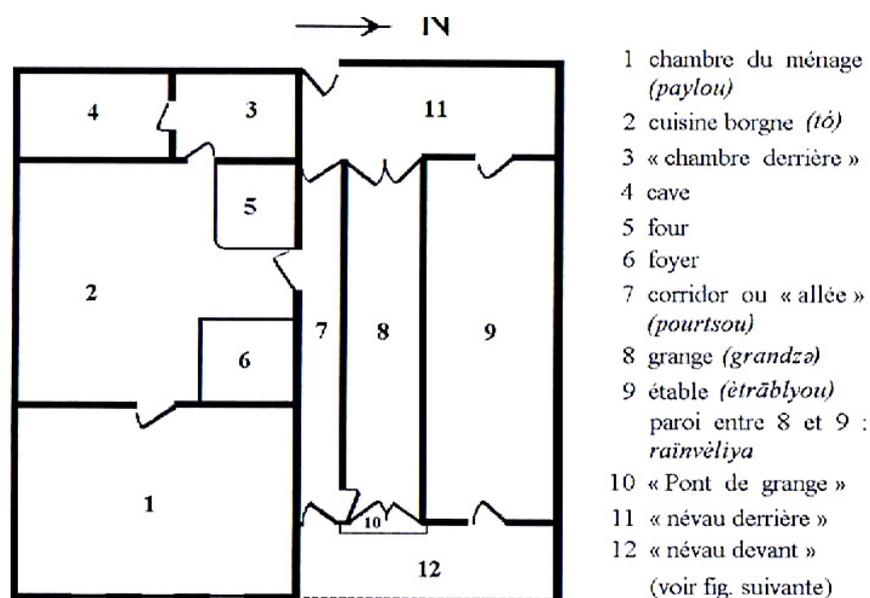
Plan d'une ferme ancienne (dimensions 20 × 20 m)
